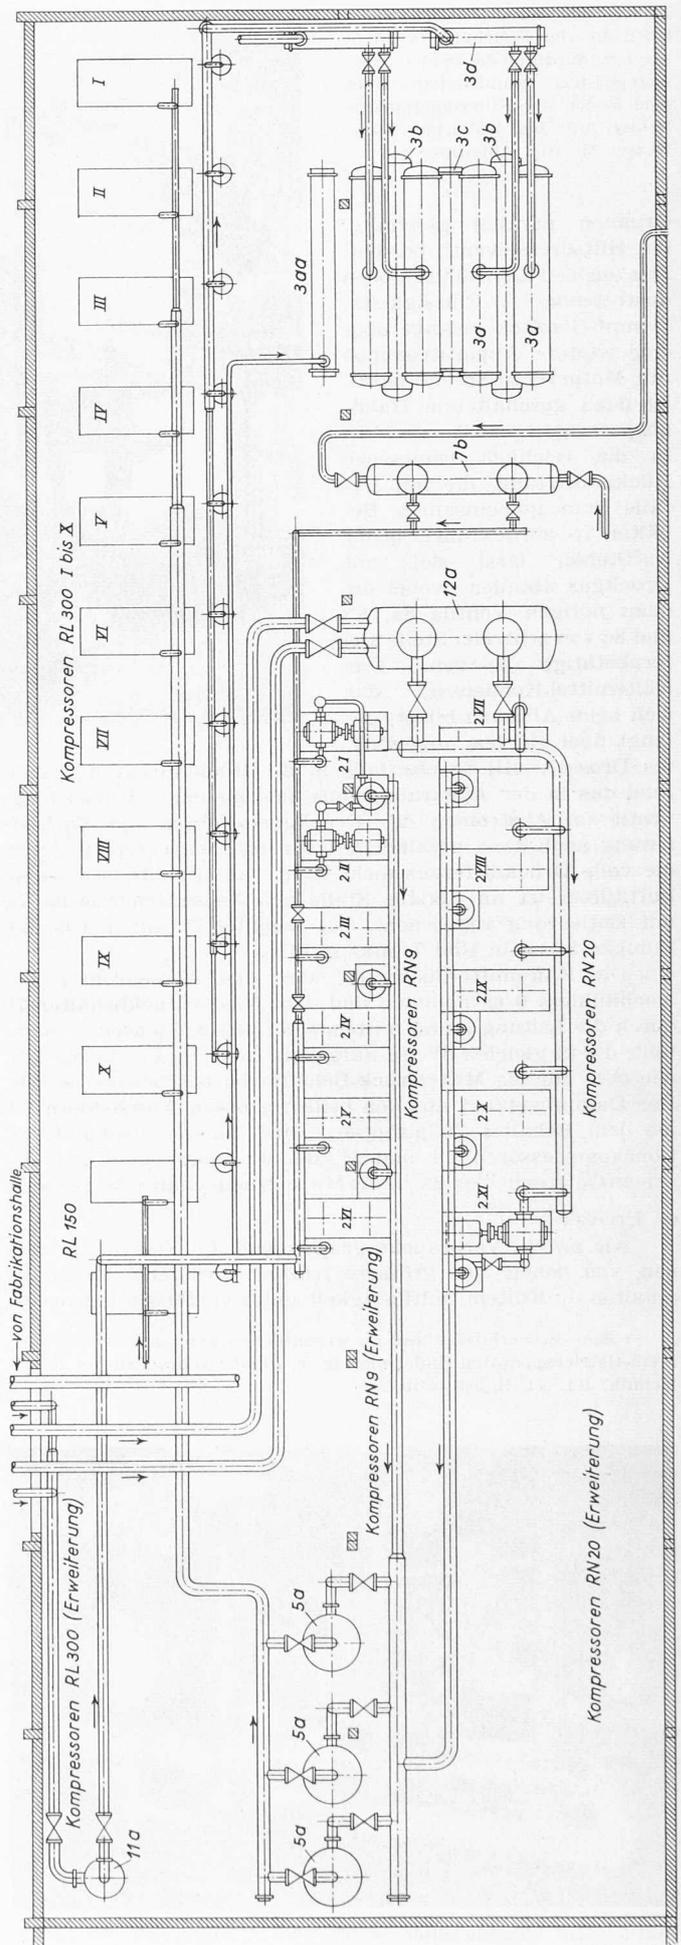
Grundriss des Maschinenraumes, 1:200, Bezeichnungen wie bei Bild 2, ausserdem 3aa Kondensator der Süsswasser-Kühlanlage
